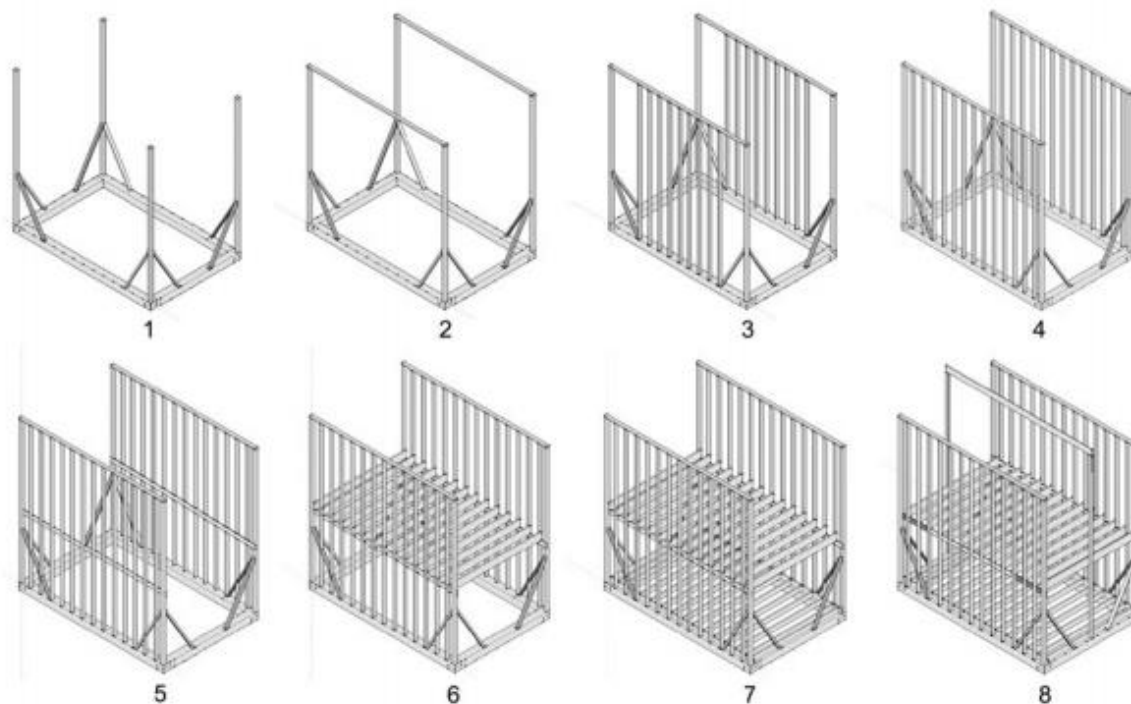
Processo de construção do “Balloon Frame” [17]
